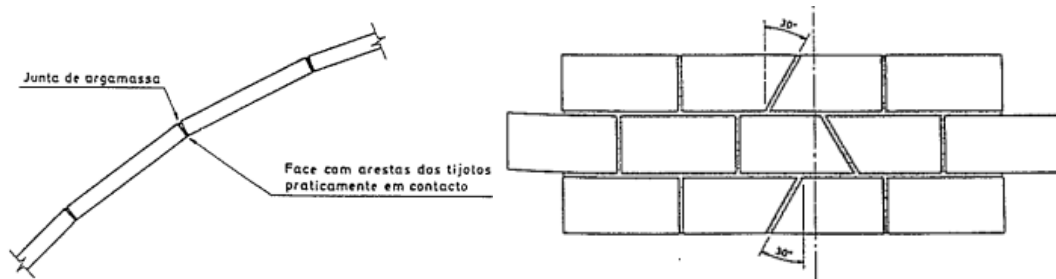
Juntas entre tijolos a) corte transversal (esq.); b) planta (dta.) [12].
